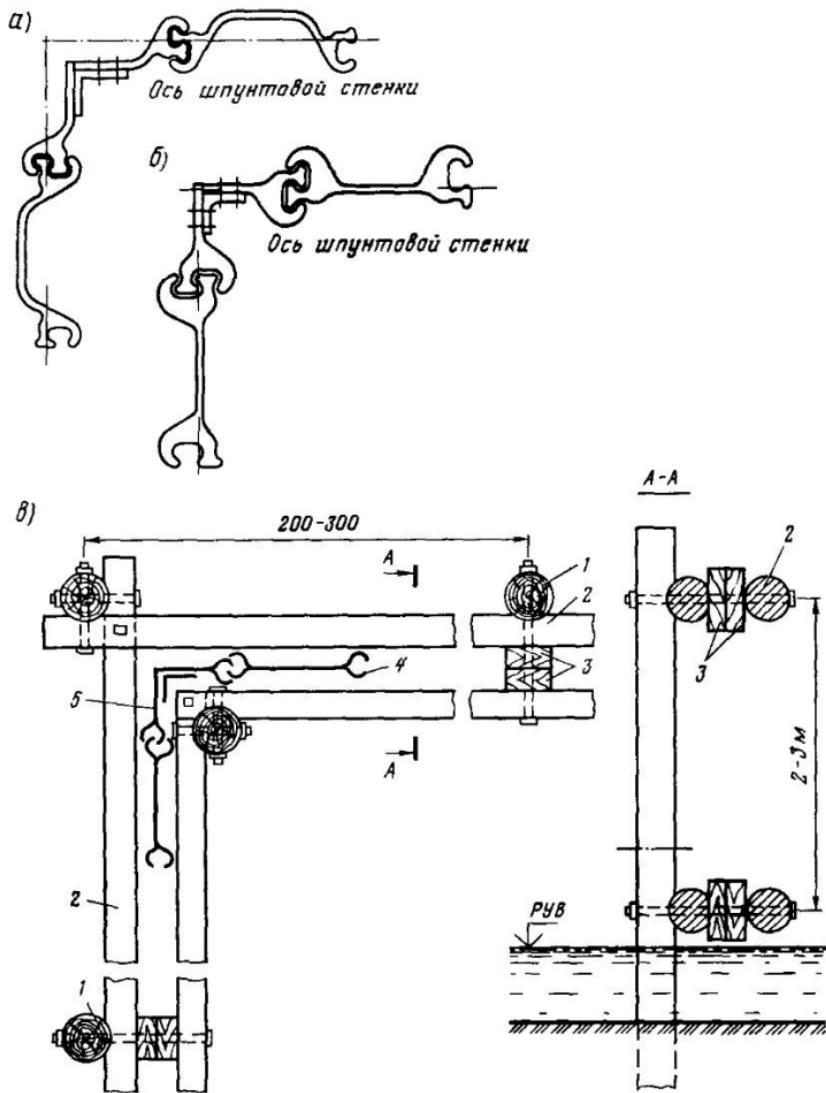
Конструкция стыков шпунтинг и направляющих для забивки шпунта:
